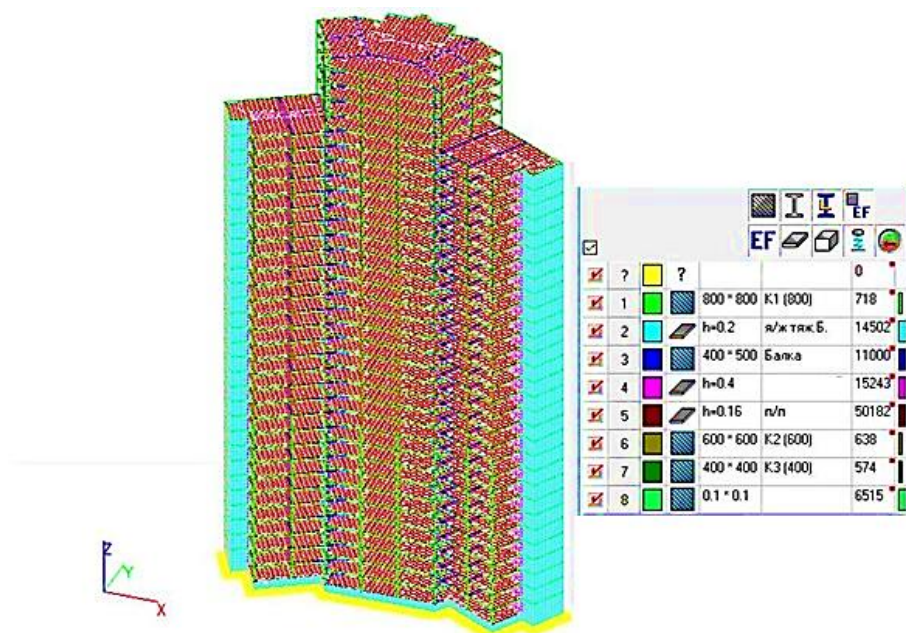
Згенерована схема залізобетонного каркасу в ПК SCAD
